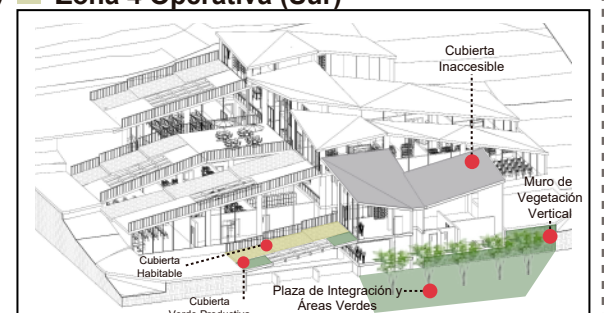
Aplicación Sistema Tipología de Sistema de Cubiertas
